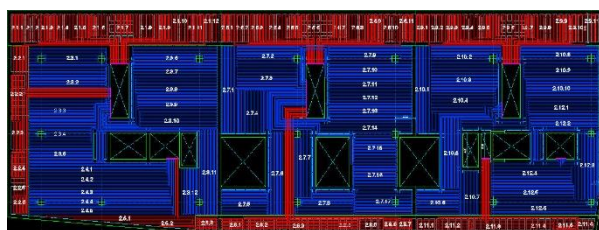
Plano constructivo de los circuitos de TABS de una planta completa de la sede de IDOM en Madrid.
